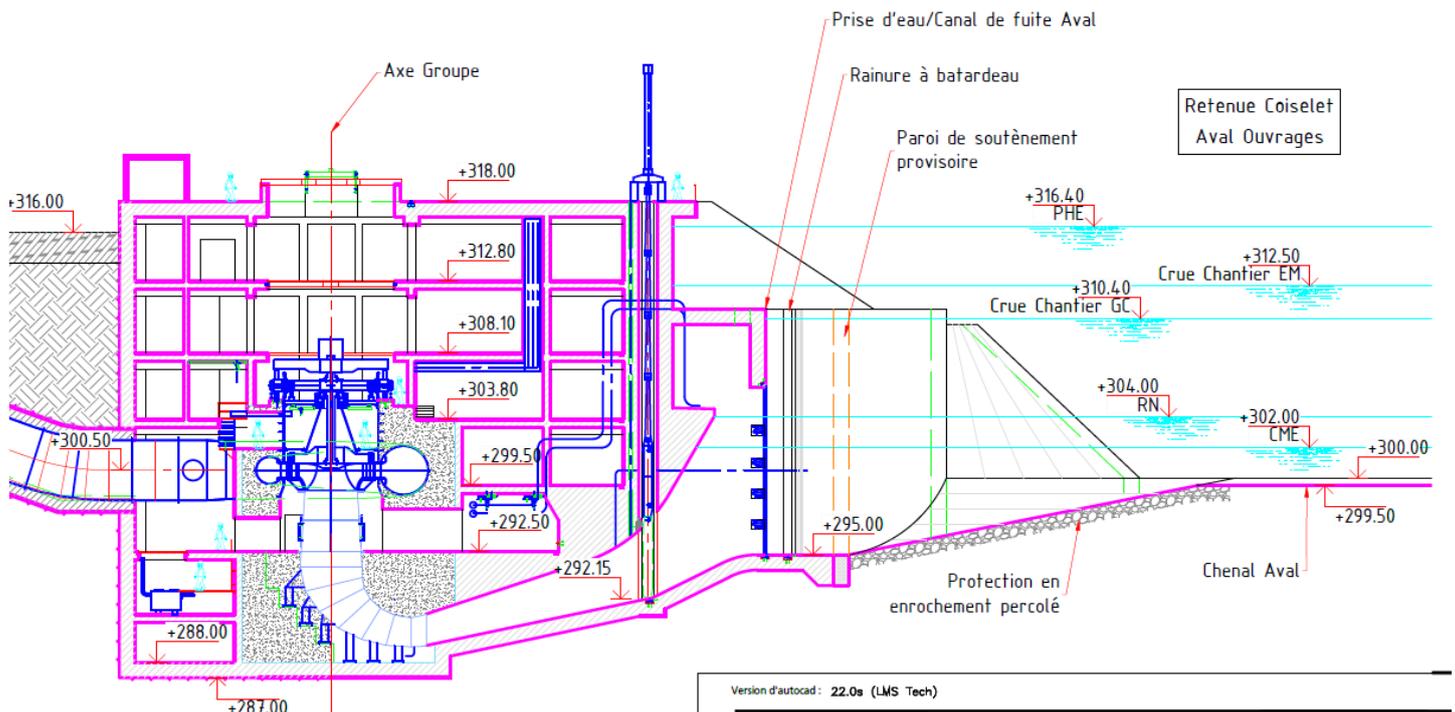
Coupe longitudinale de la prise d'eau inférieure
